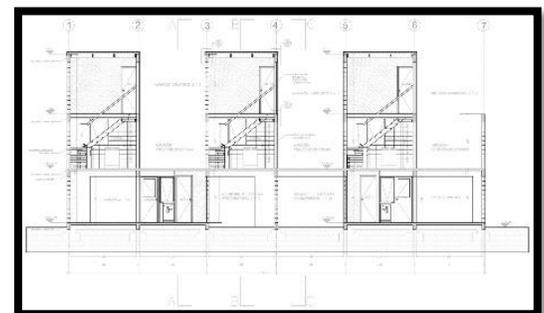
Coupe longitudinale du projet.(source:archdaily.com).
